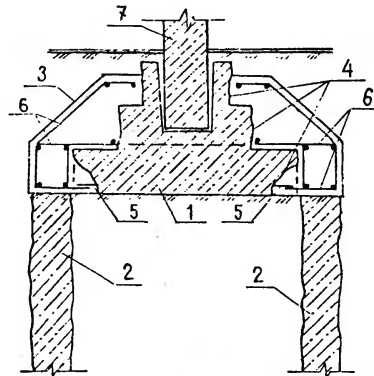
Передача нагрузки от фундамента на буронабивные сваи
